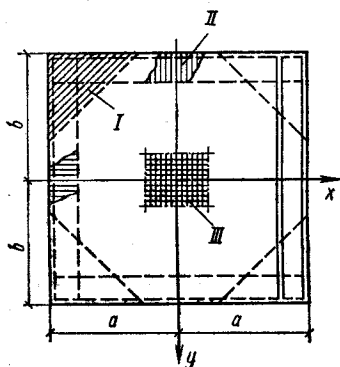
Схема армирования пологой оболочки двойной кривизны, прямоугольной в плане I...III — типы арматуры
